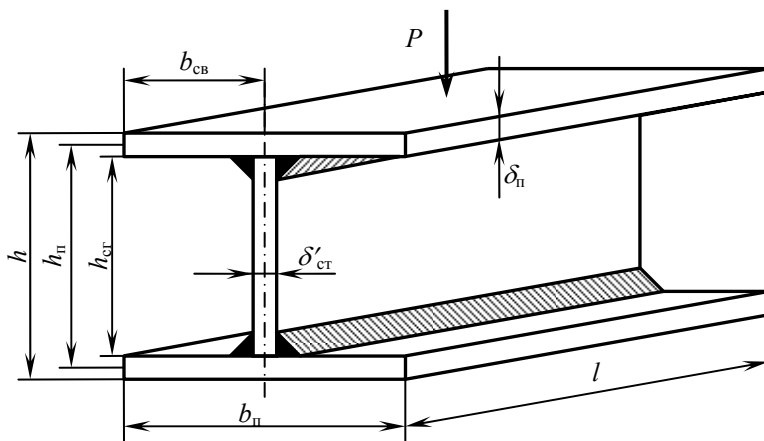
Расчётная схема балки сварной составной конструкции
